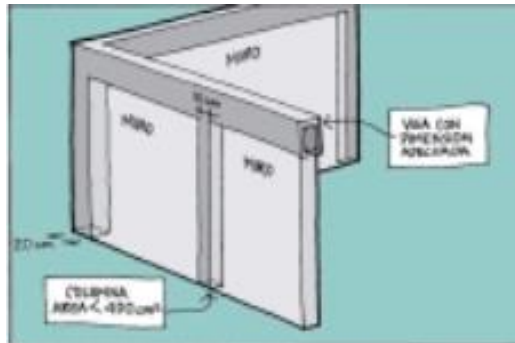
Detalles columna y viga - V. Media (AIS, 2001)
